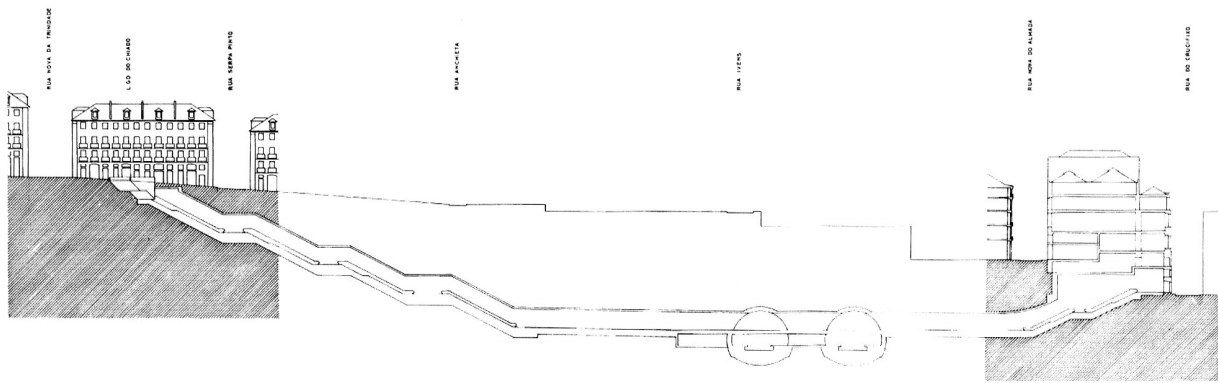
Corte longitudinal da Estação Baixa-Chiado
